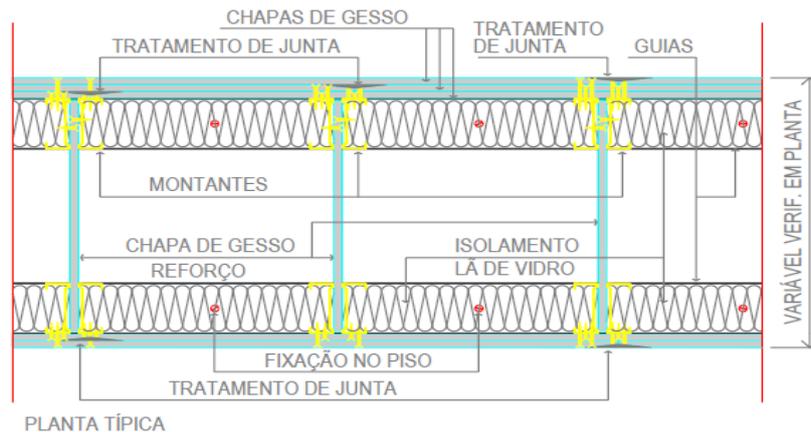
Parede de drywall com alto desempenho acústico. Fonte: DE LIMA, 2014
